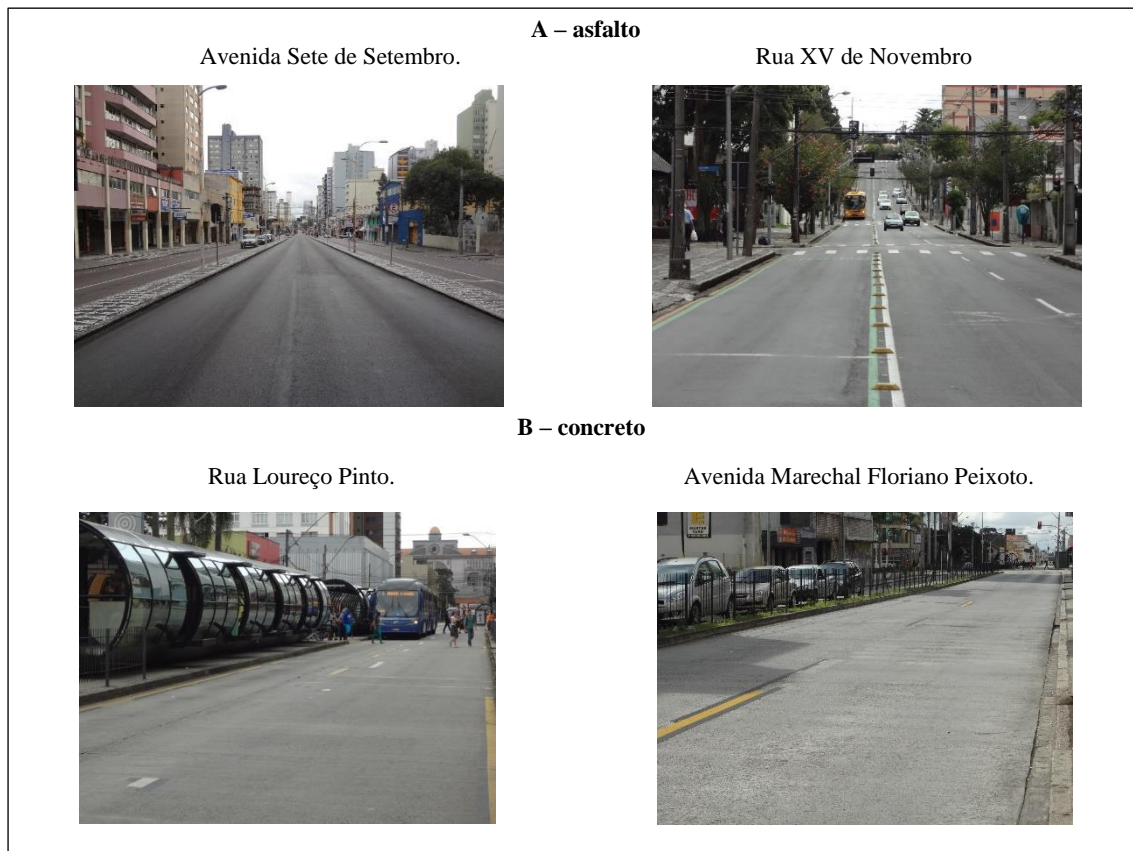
Curitiba, exemplos de pavimentos em asfalto e em concreto.
